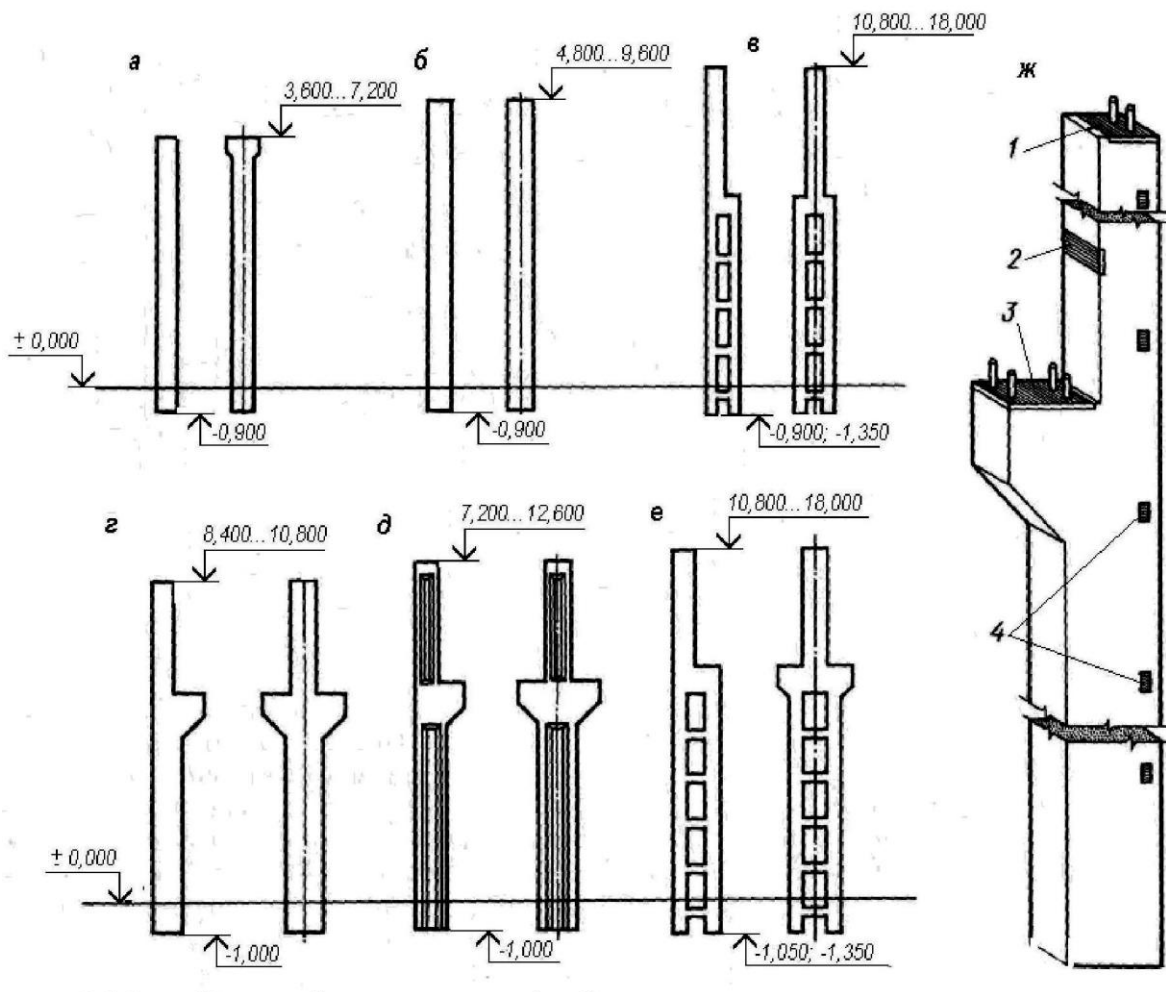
Основні типи залізобетонних колон одноповерхових виробничих будівель [1]: *а* – прямокутного перерізу для будівель без мостових кранів при кроці колон 6 м; *б* – те ж при кроці колон 12 м, *в* – двогілкові для будівель без мостових кранів, *г* — прямокутного перерізу для будівель з мостовими кранами, *д* – те ж, двотаврового перерізу, *е* – двогілкові для будівель з мостовими кранами, *ж* – загальний вид колони;
